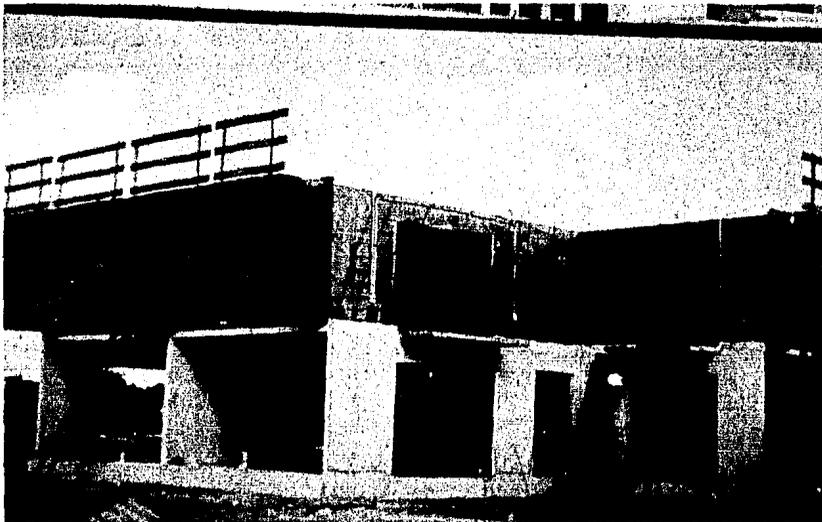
Cimbrado de la planta alta en el módulo de 4 casas.
